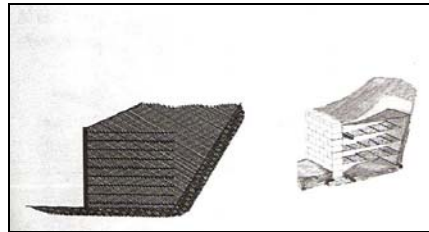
Estructura en Suelo Reforzado con Refuerzo Metálico
